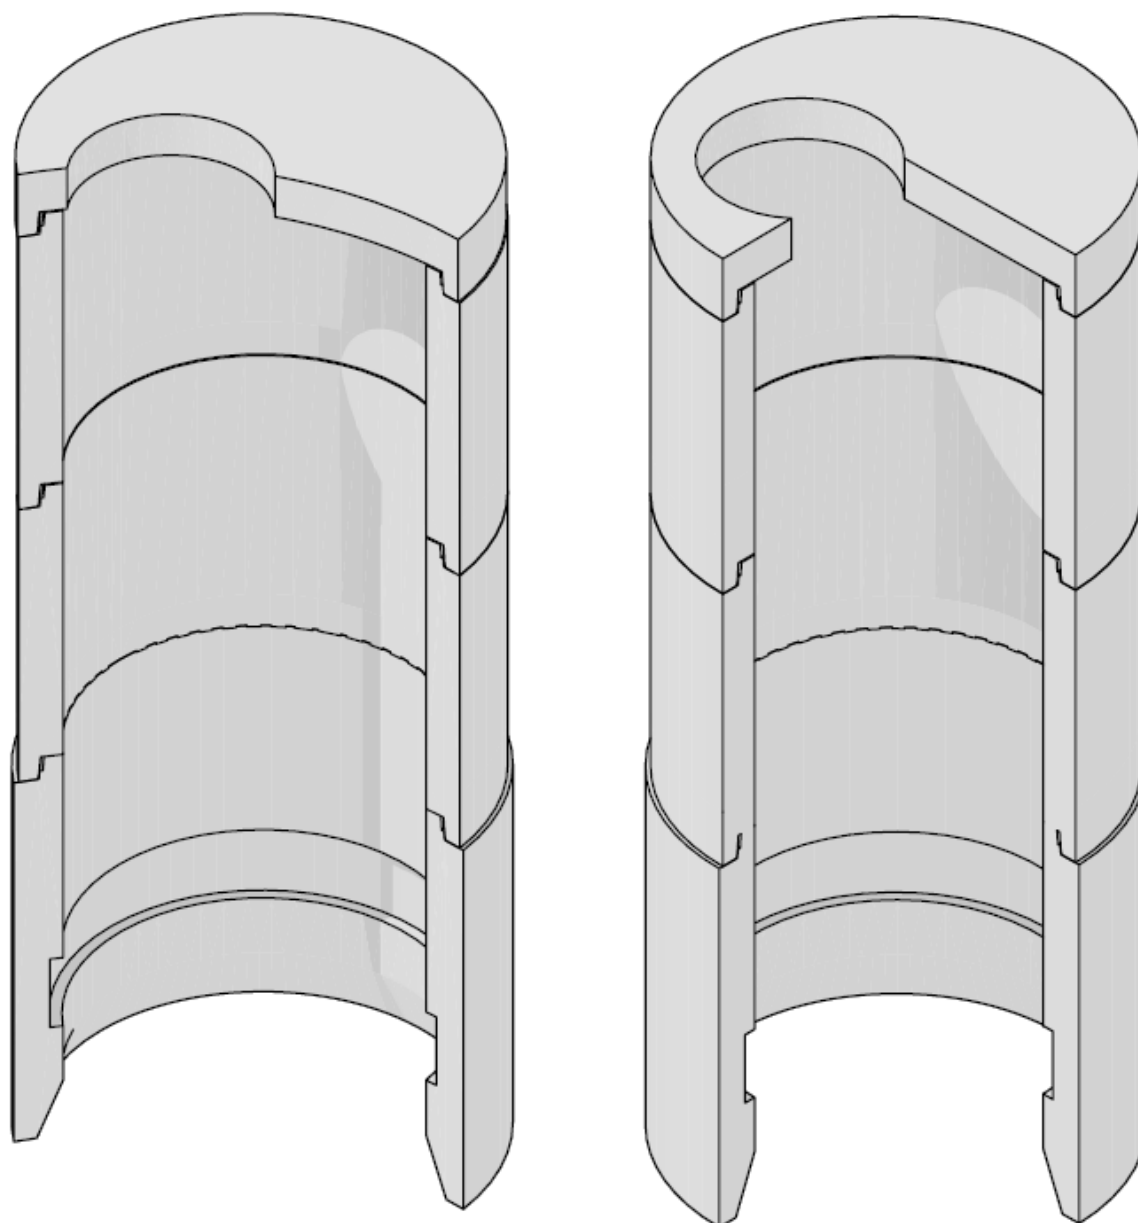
Wizualizacja przykładowego schematu studni TORNADO 2
